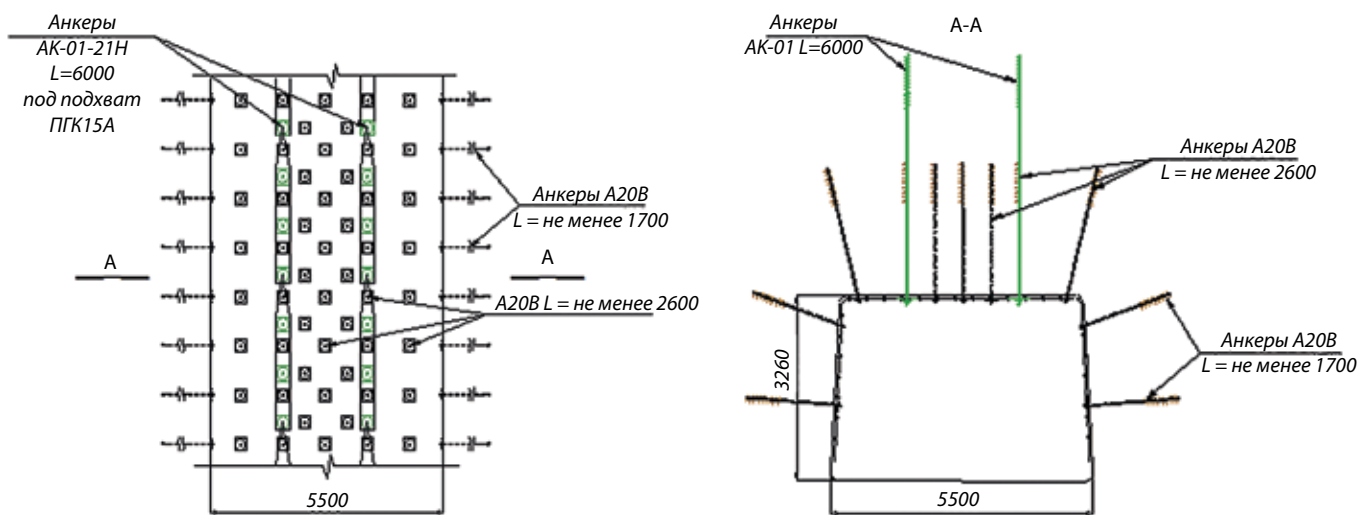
Схема крепления вентиляционного штрека № 26-52 канатными анкерами АК01-21Н с продольными гибкими подхватами ПГК15А
